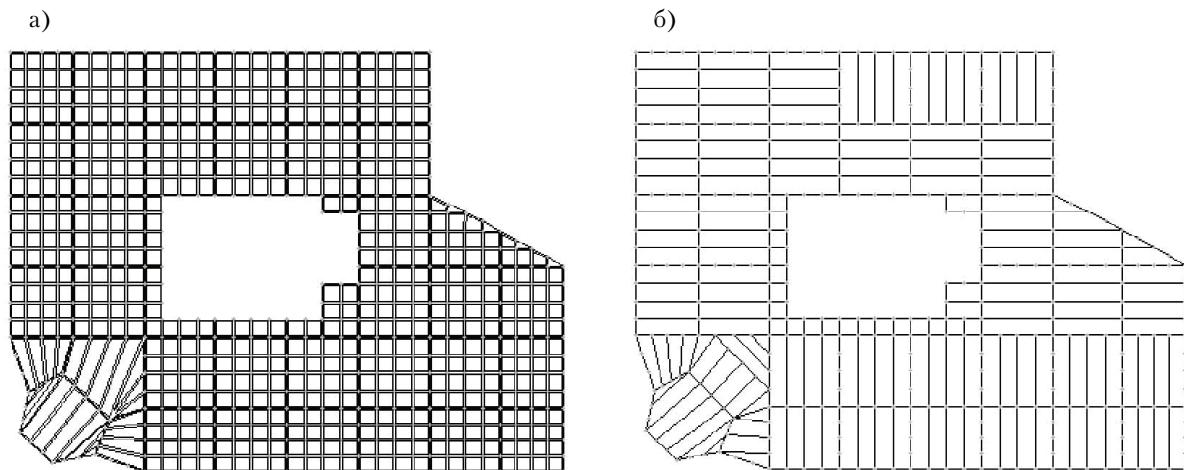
Планы типового этажа здания: а – железобетонный каркас; б – металлический каркас.
